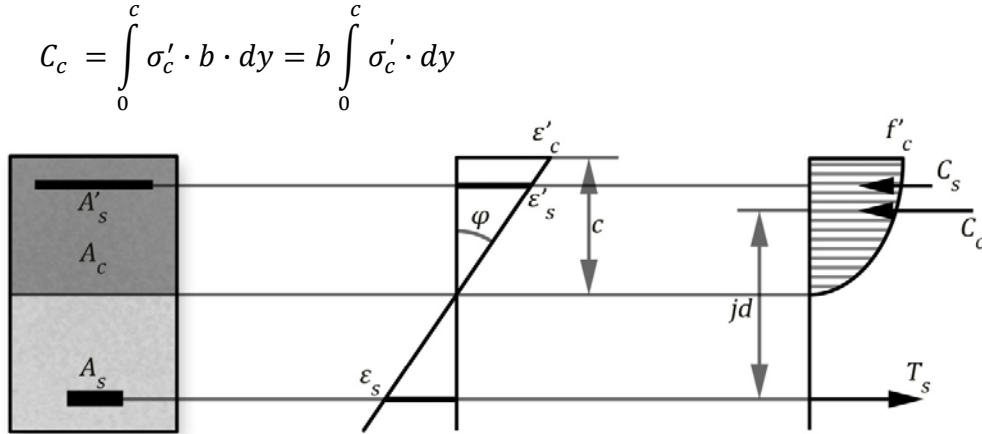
,26: Ecuaciones de equilibrio. Sección rectangular
